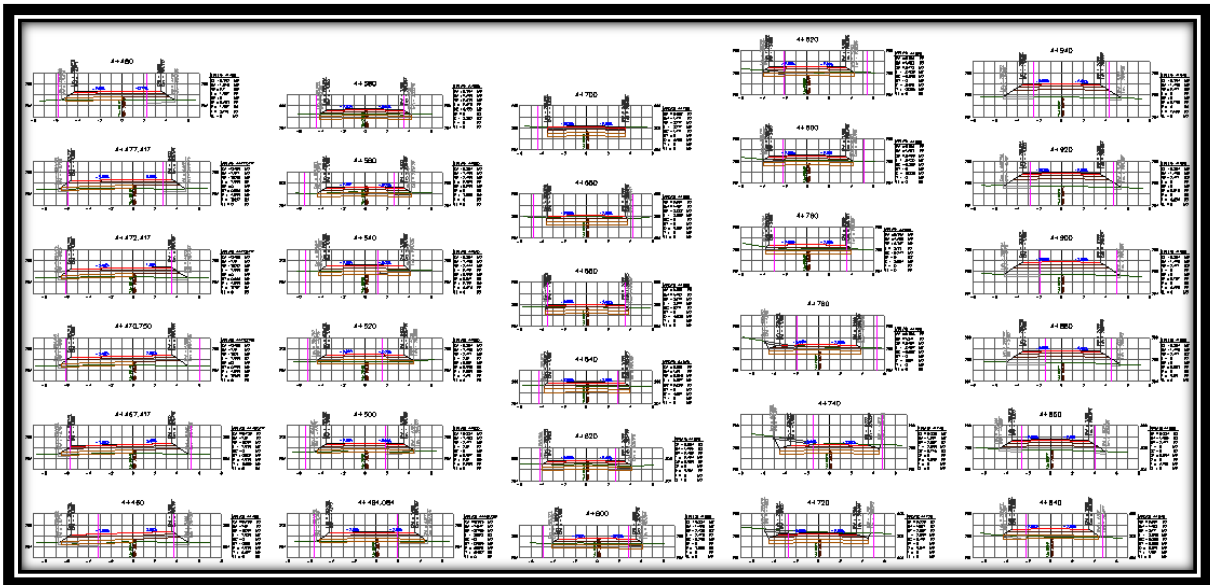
Secciones de construcción del km 4+460.000 al km 4+940.000.
